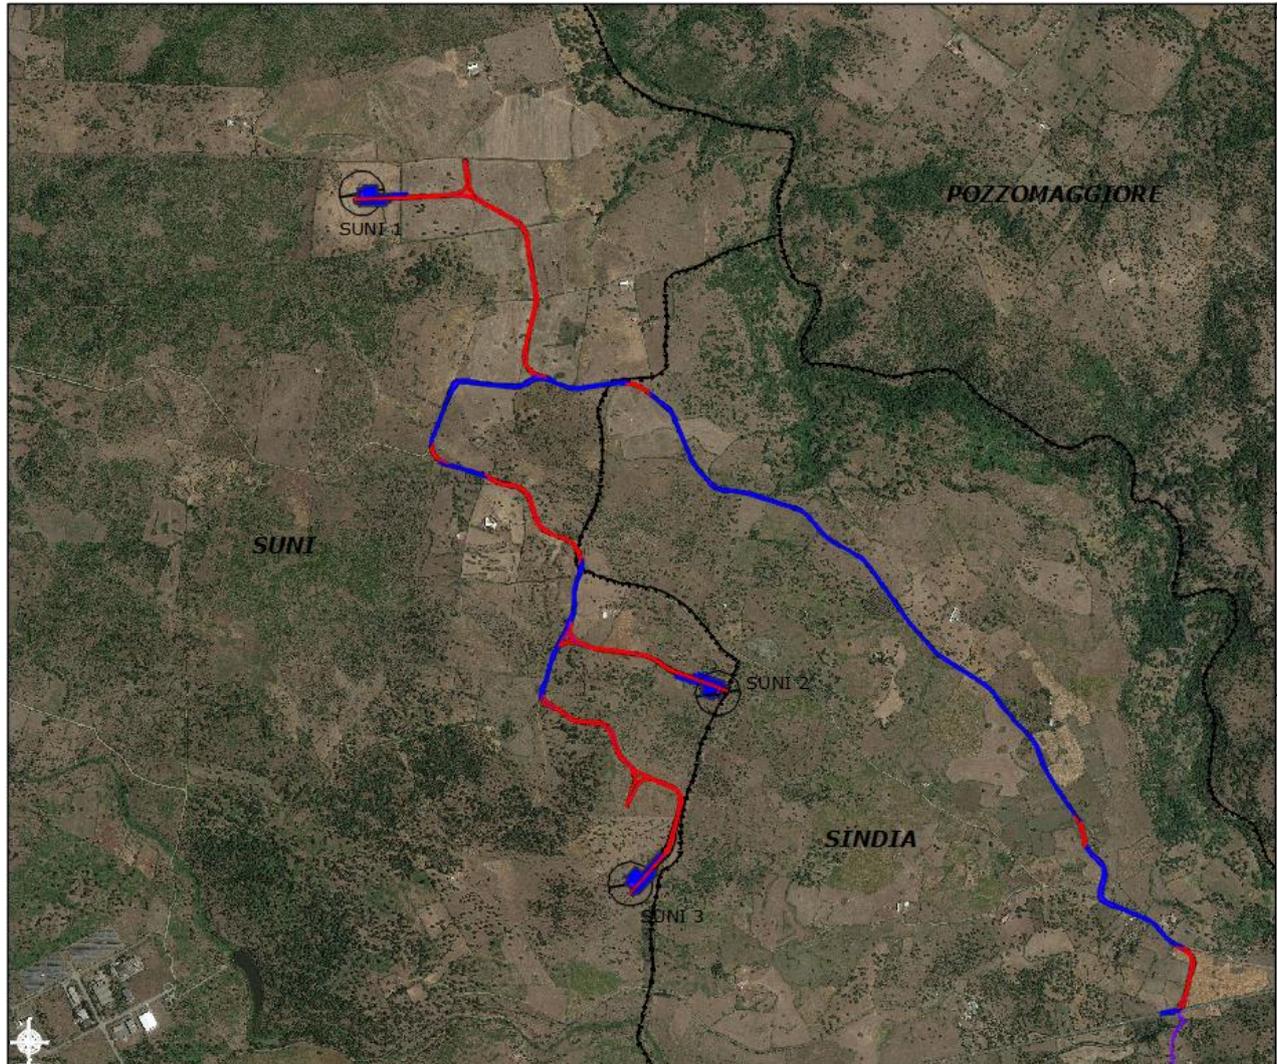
Primo inquadramento dell'ubicazione delle WTG, della viabilità di impianto e del cavidotto su base ortofoto
